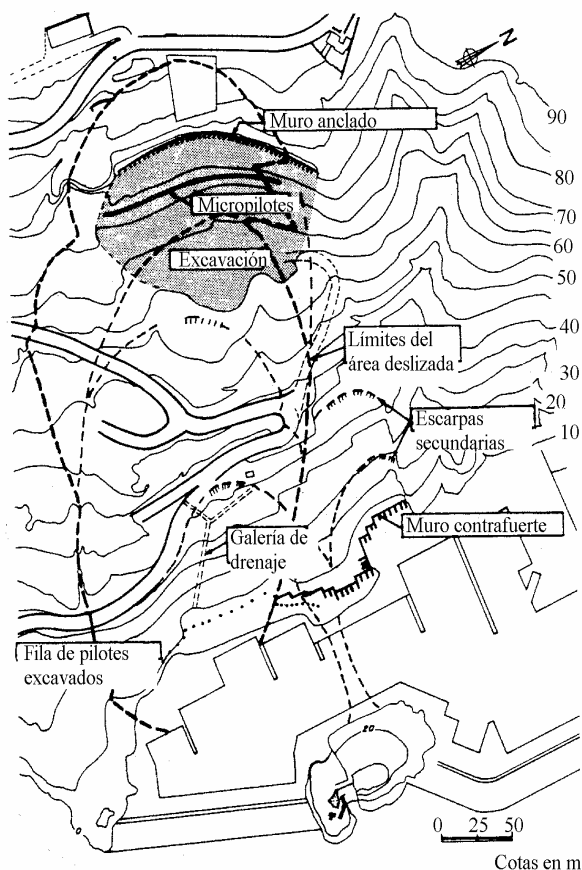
Plano del deslizamiento, indicando obras de estabilización (Rodríguez et al, 1984).
